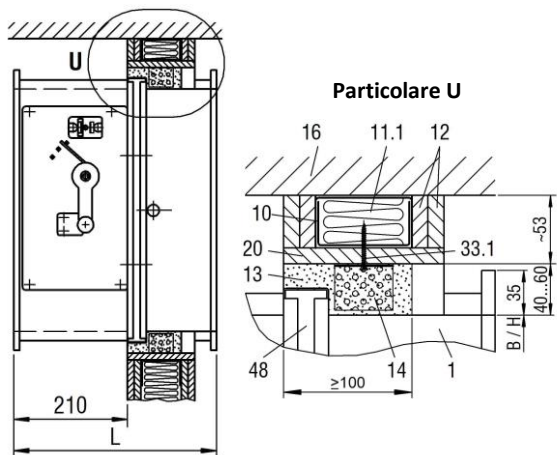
montaggio umido in pareti divisorie leggere direttamente sotto soffitti massicci
